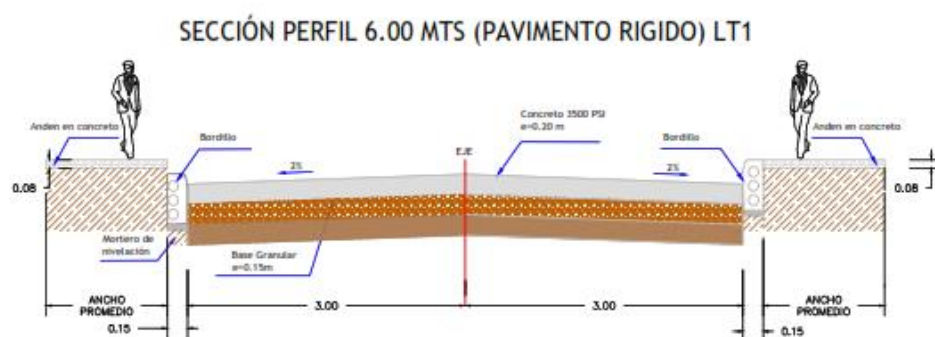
Corte Frontal de diseño del pavimento fuente: Planeación Alcaldía Cerrito
